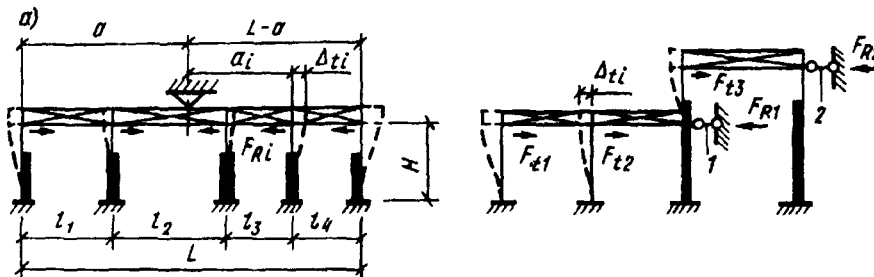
Расчетные схемы рам при определении температурных перемещений
